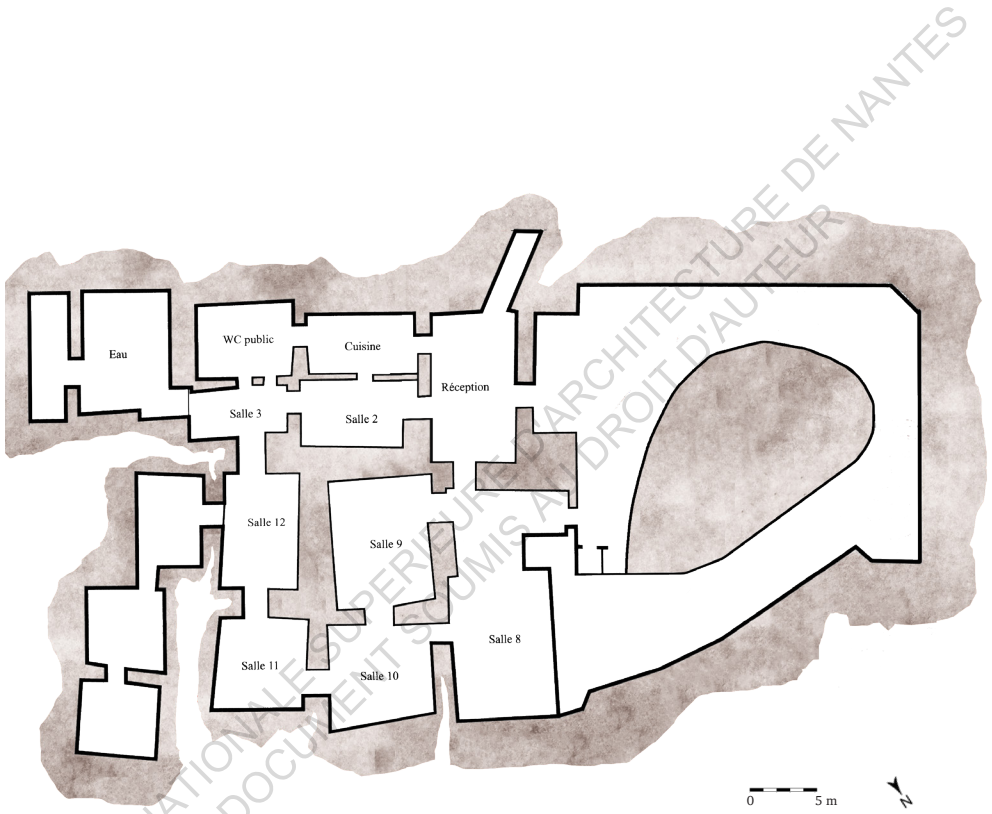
Plan du site des Cathédrales de la Saulaie avec salles de restaurant, Doué-la-Fontaine, 2021.
